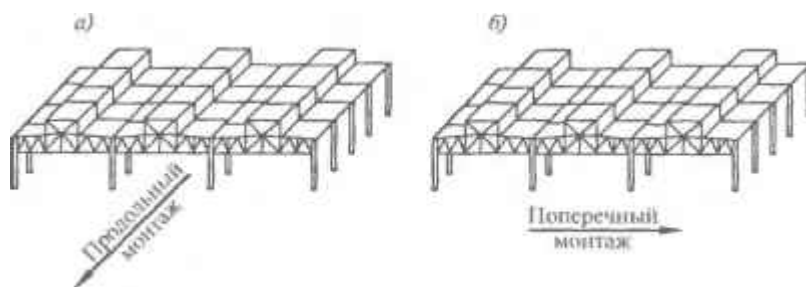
Схемы продольного - (а) и поперечного - (б) монтажа каркаса здания
